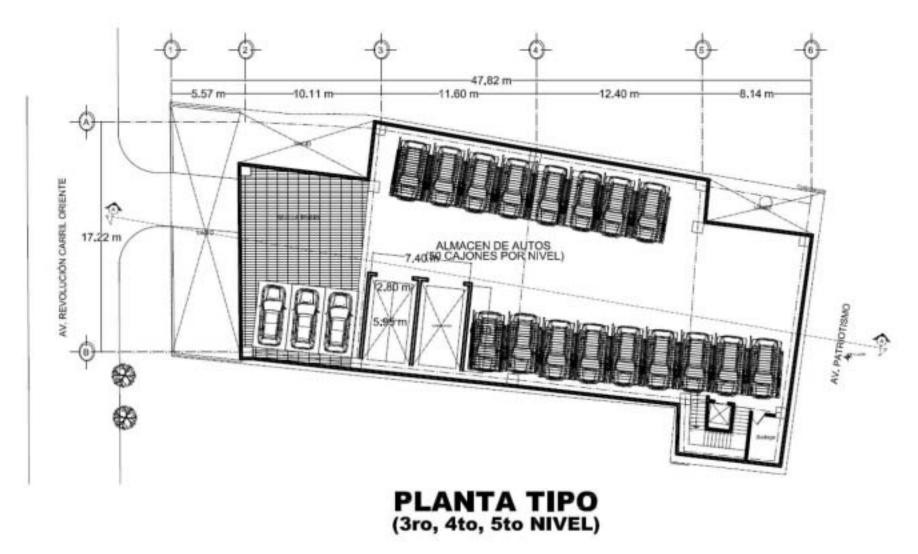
Planta tipo para los niveles del 3er al 5to. niveles 13.85, 18.35 Y 22.85.
